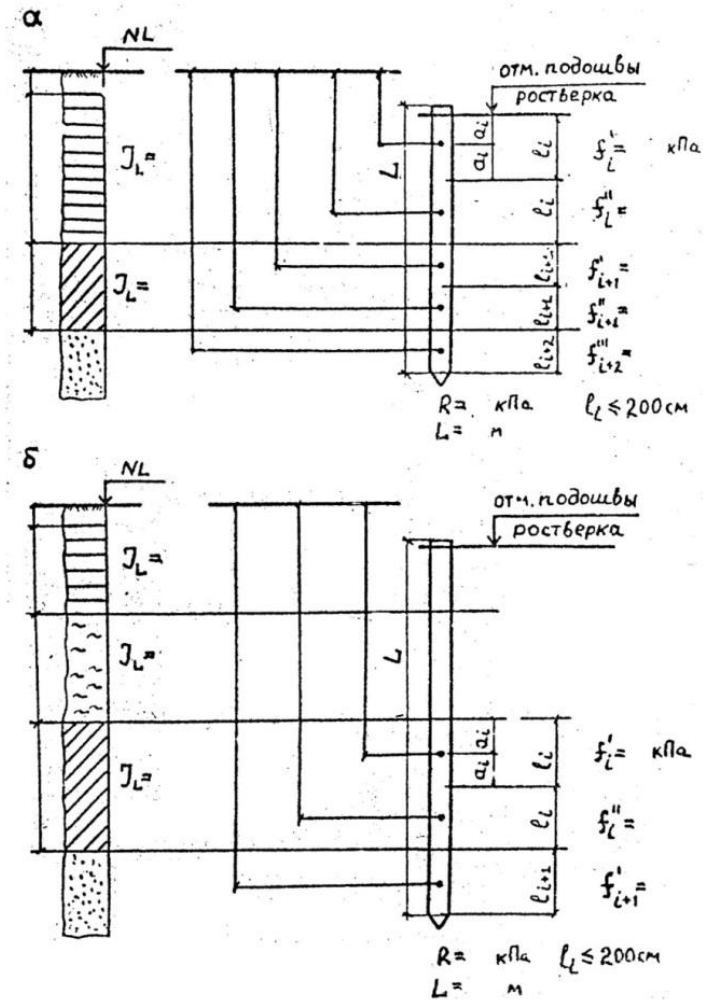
Схема для определения несущей способности одиночной сваи по грунту для фундамента Ф₃:
